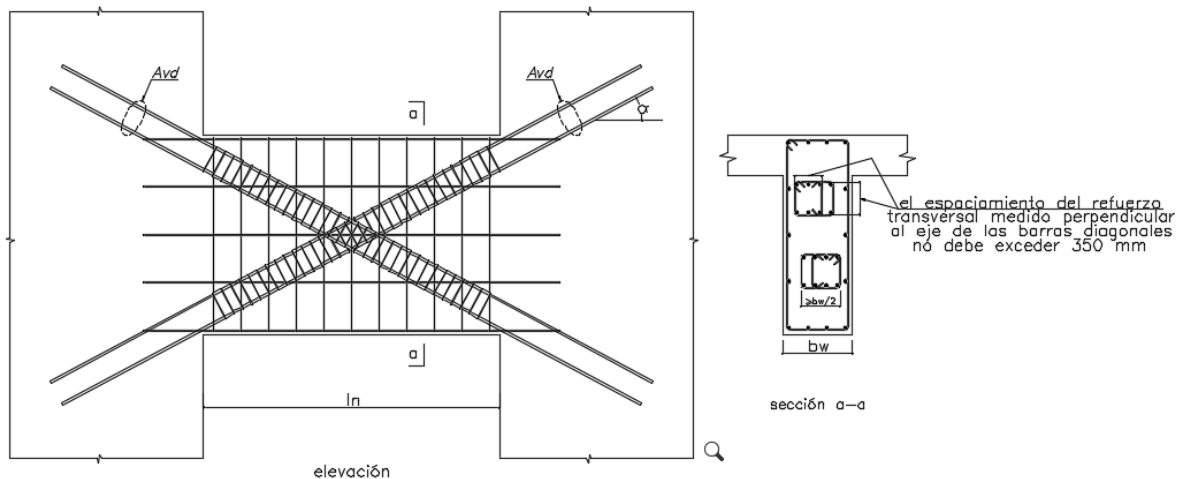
i Refuerzo de vigas de acople
